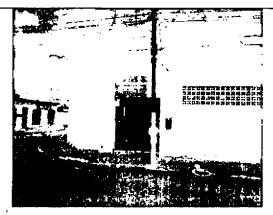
fachada - entrada Fonte Arquivo Pessoal (dezembro 2020)
